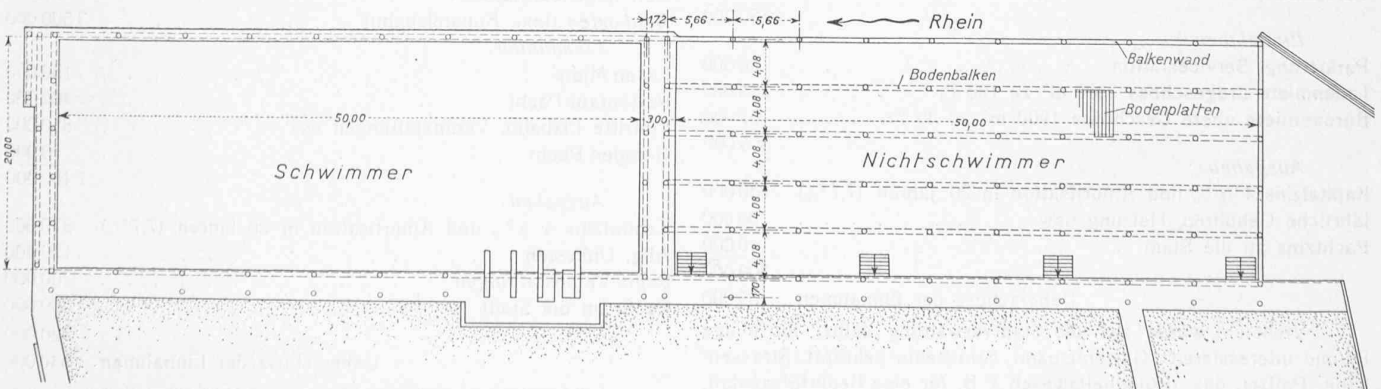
Gesamtplan der Eisenbeton-Wasserbauten für das Flussbad Rheinfelden. — Ing. M. Schnyder, Burgdorf. — Masstab 1 : 600.
